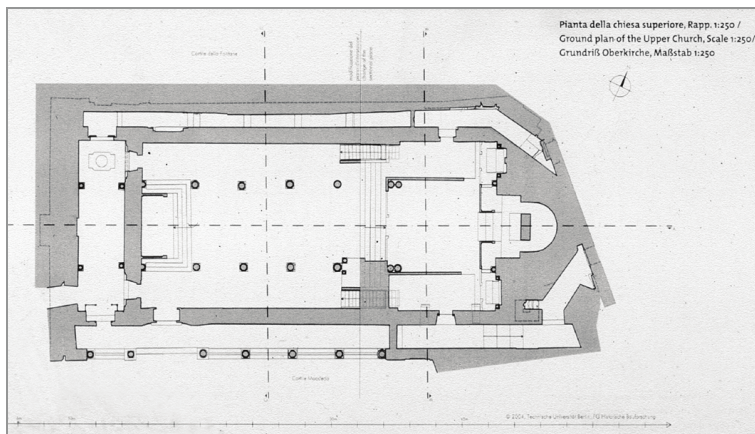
Cappella Palatina, Palermo, Grundriss der Oberkirche
